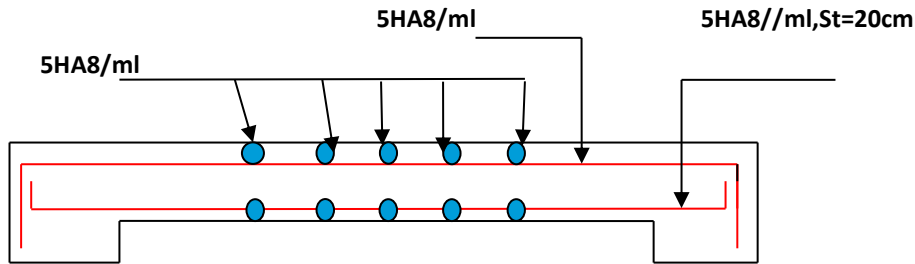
Détail de ferrailage dalle pleine sur trois appuis
